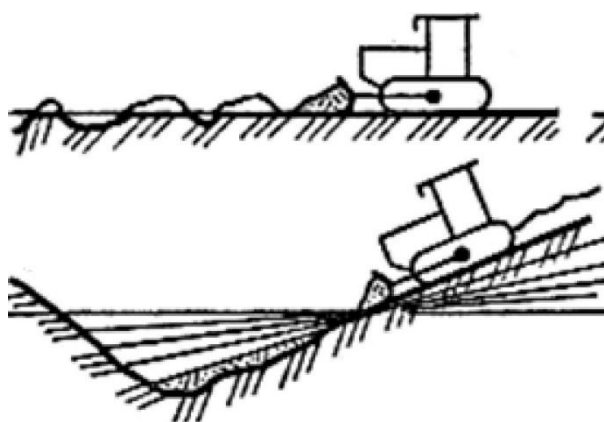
Планировка со срезкой бугров и засыпкой впадин параллельными проходками и с перемещением больших масс грунта
